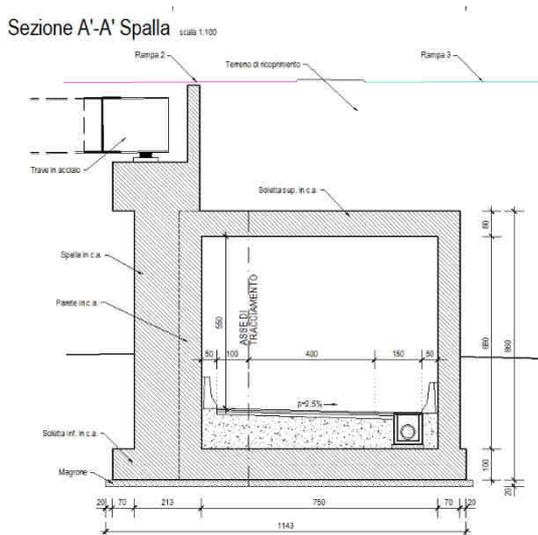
Sezione trasversale in corrispondenza dell'attraversamento delle rampe 2 e 3 - Sottovia svincolo SS.125 ramo B
